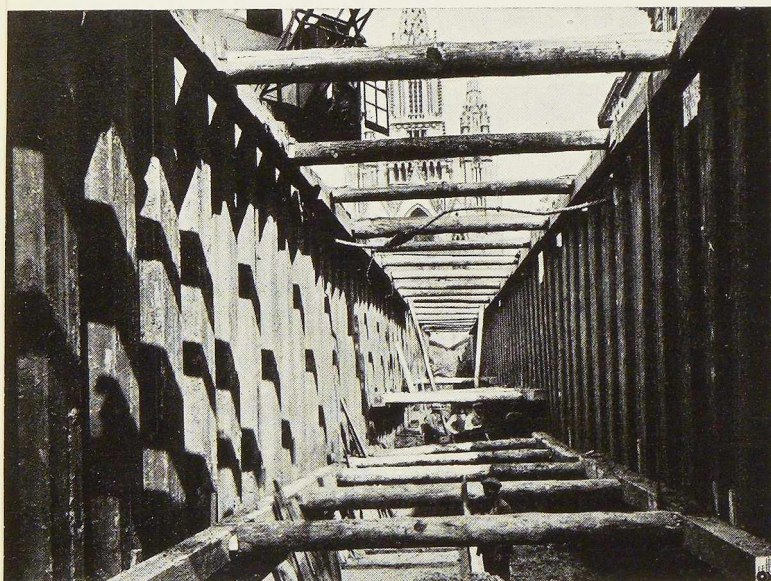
Construction du passage inférieur de l'avenue de la Reine à Bruxelles. On y a utilisé 1.770 tonnes de palplanches Belval Z III.
